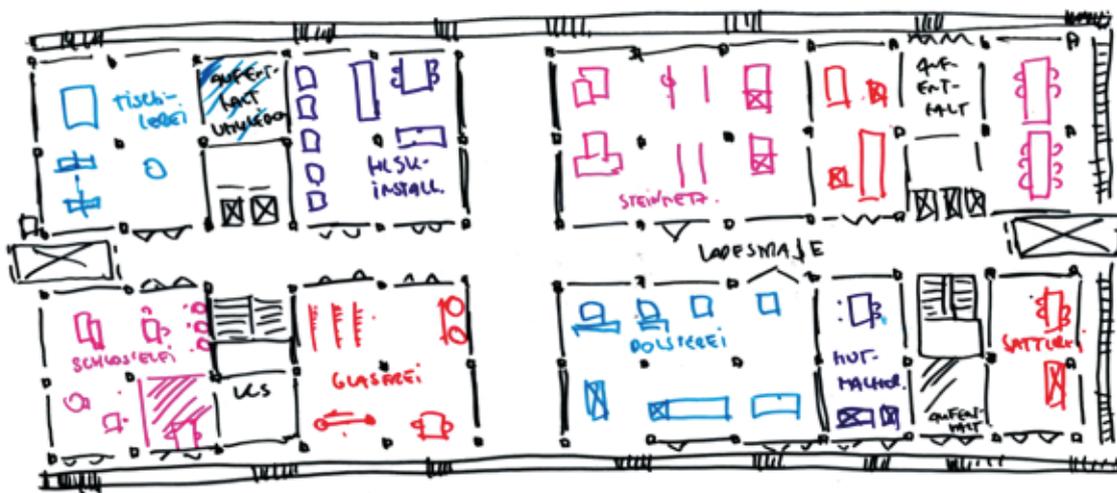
Grundriss 3.OG Hauptgebäude Gewerbegebiet
